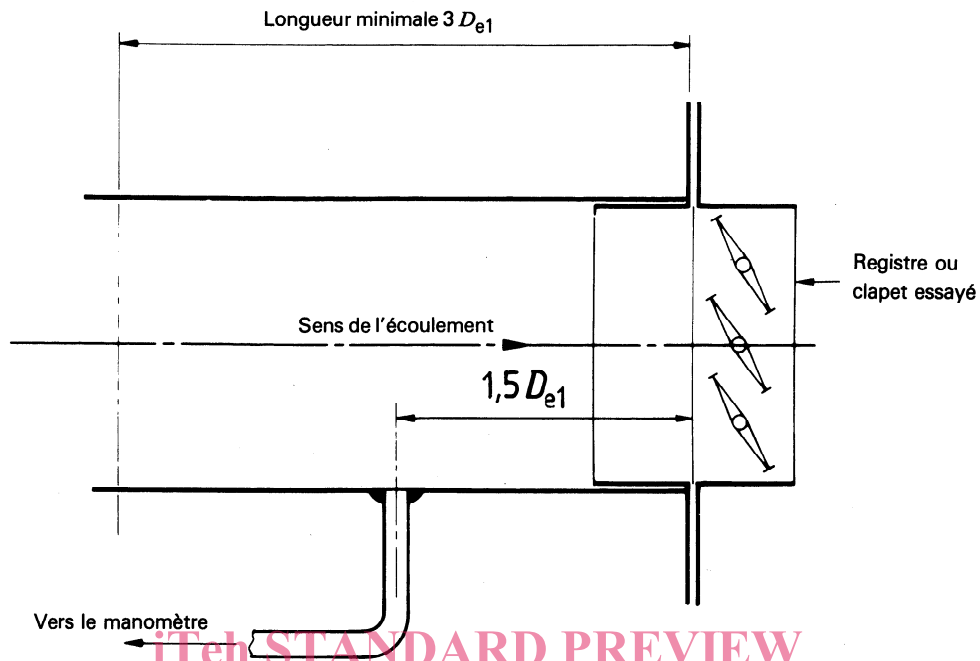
Conduit d'essai pour détermination du débit de fuite
